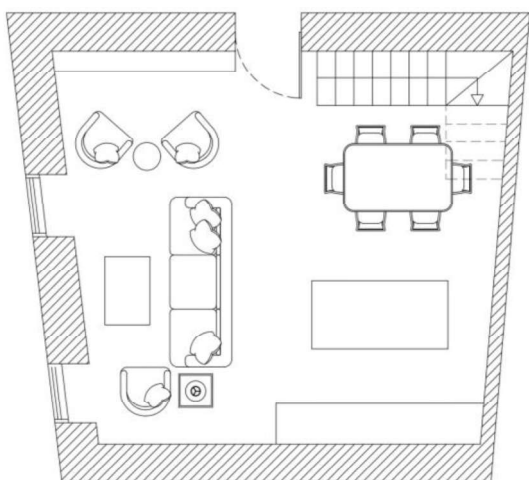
Planta do alojamento rural, proposta I, piso inferior. Fonte: Autor
